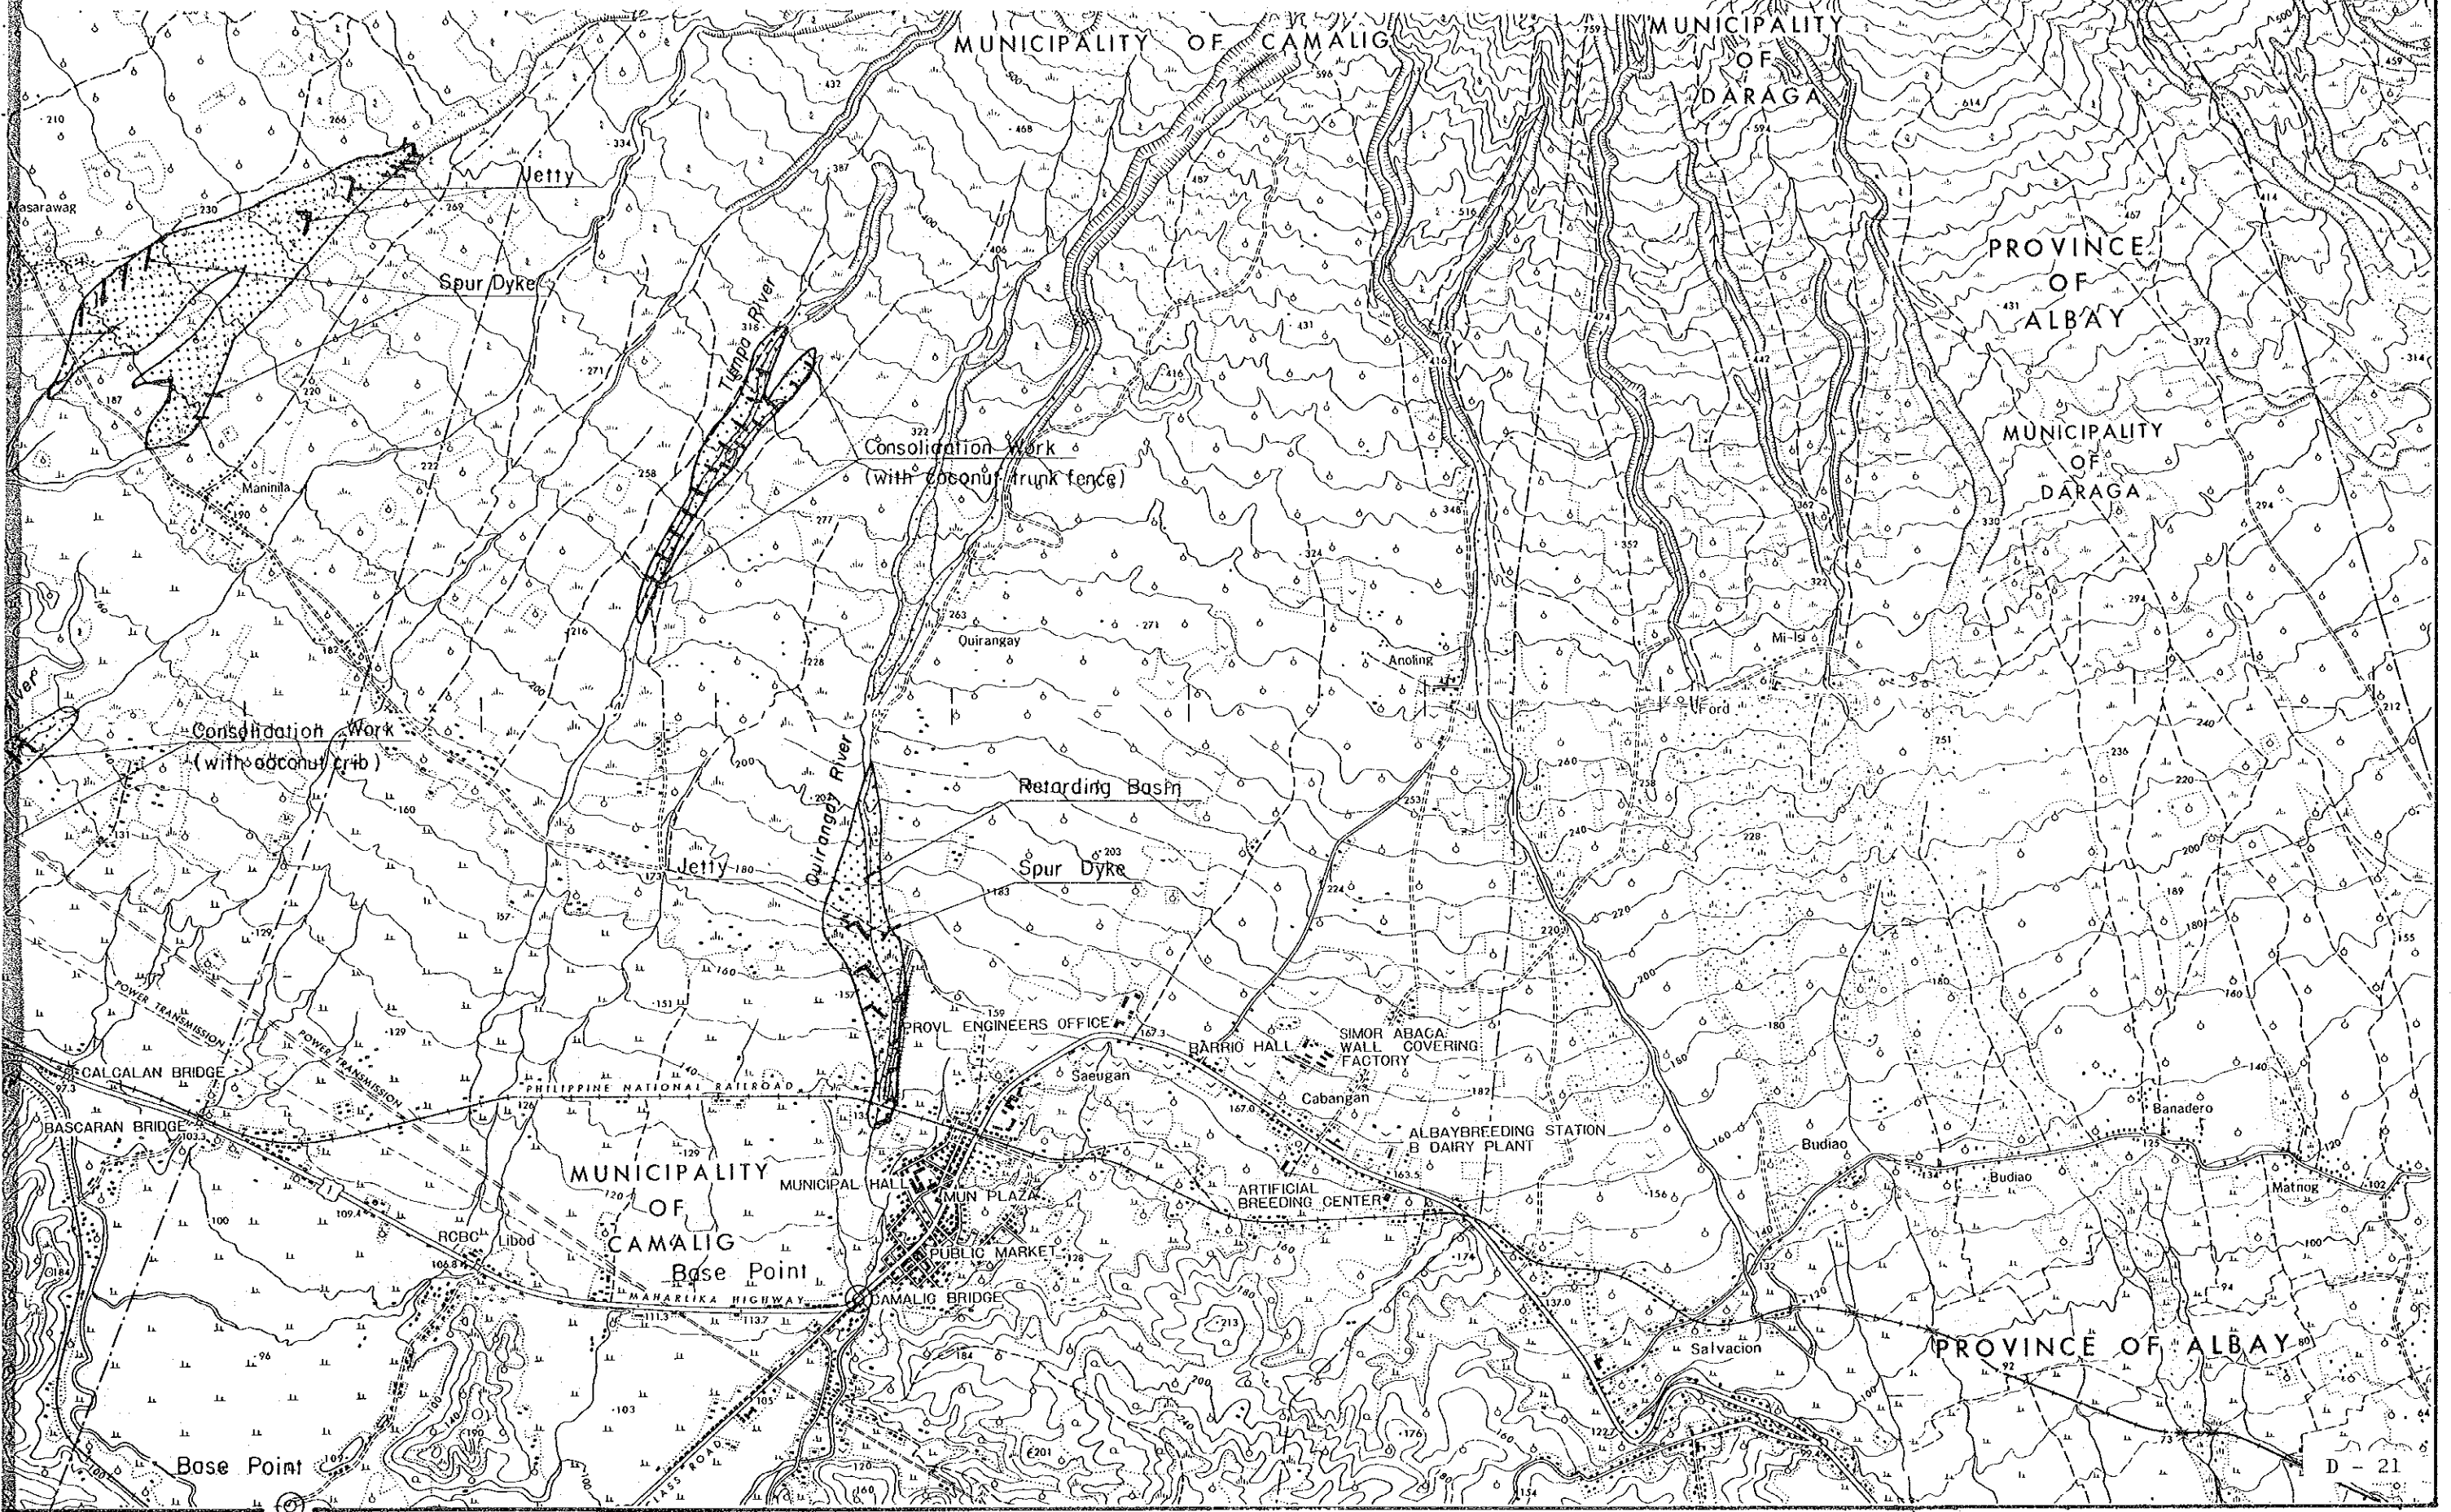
キナリ(A)川流域の砂防施設配置図
